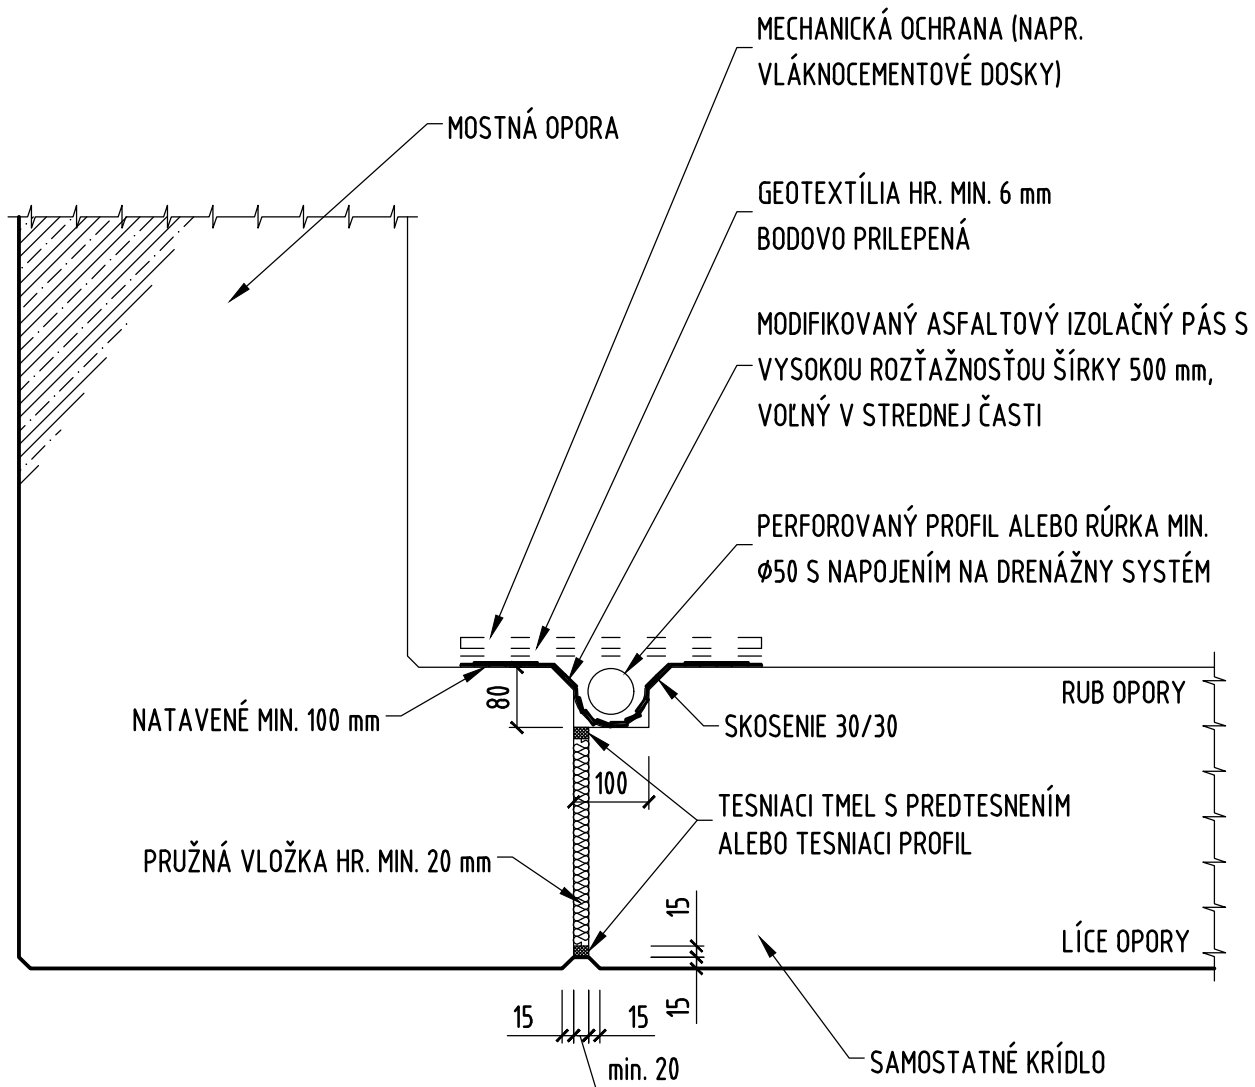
DETAIL DILATAČNÝ POHYB DO ± 10 mm
